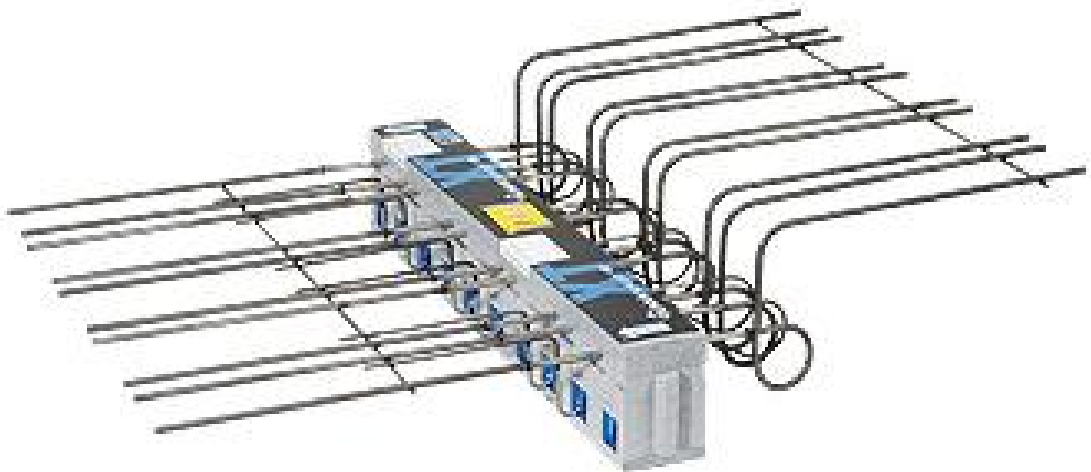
Schöck Isokorb KXT ja KFXT -lämmöneriste-elementti. [1.]
